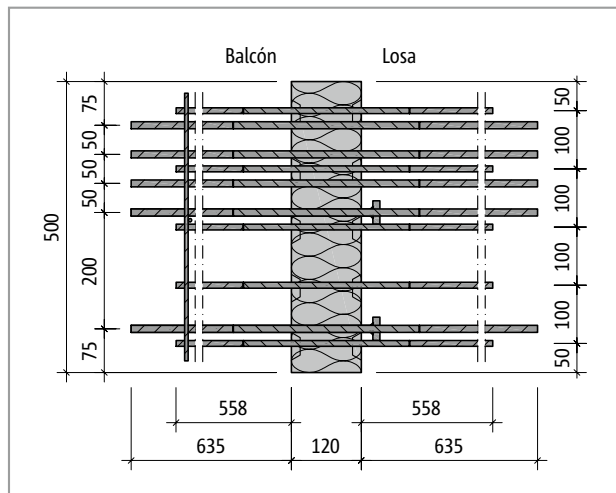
Schöck Isokorb® XT tipo C-L-M1-V1: Plano del producto
